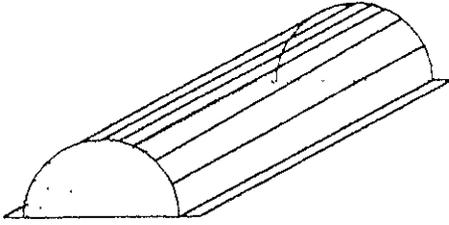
(continuación). Forma de la cimbra que le da un aspecto curvo entre las vigas
